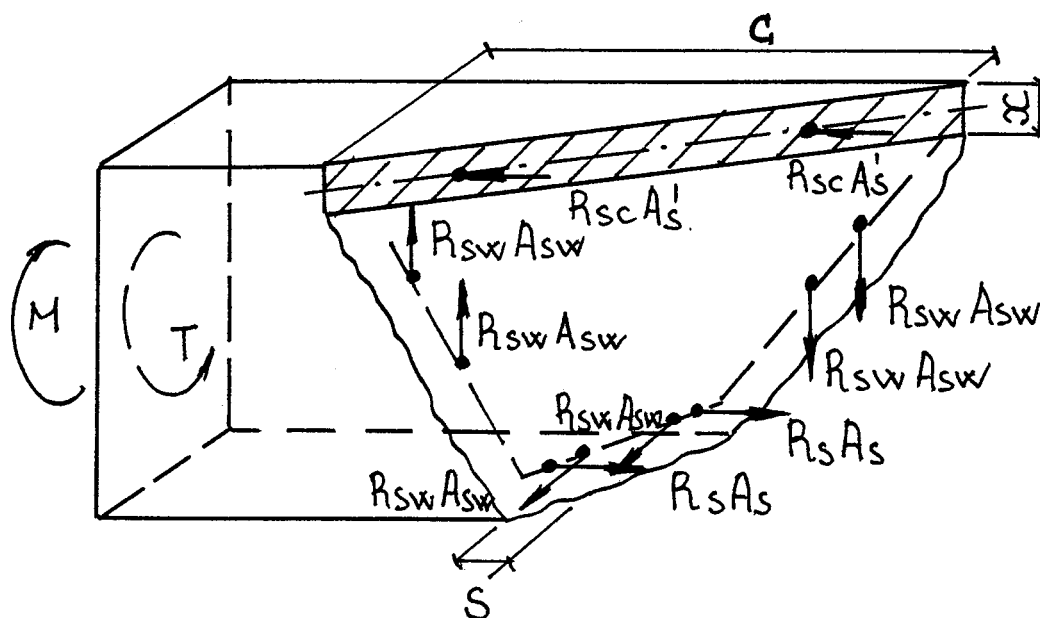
К расчету элементов прямоугольного сечения, работающих на изгиб с кручением
